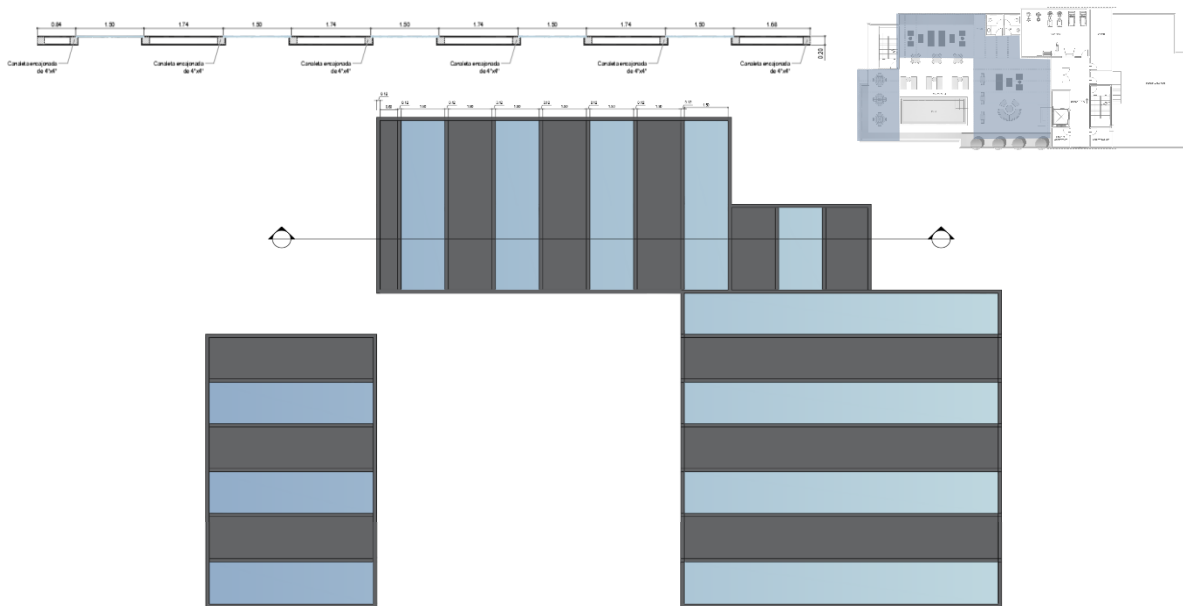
Detalle de pérgolas de azotea Hotel Courtyard
